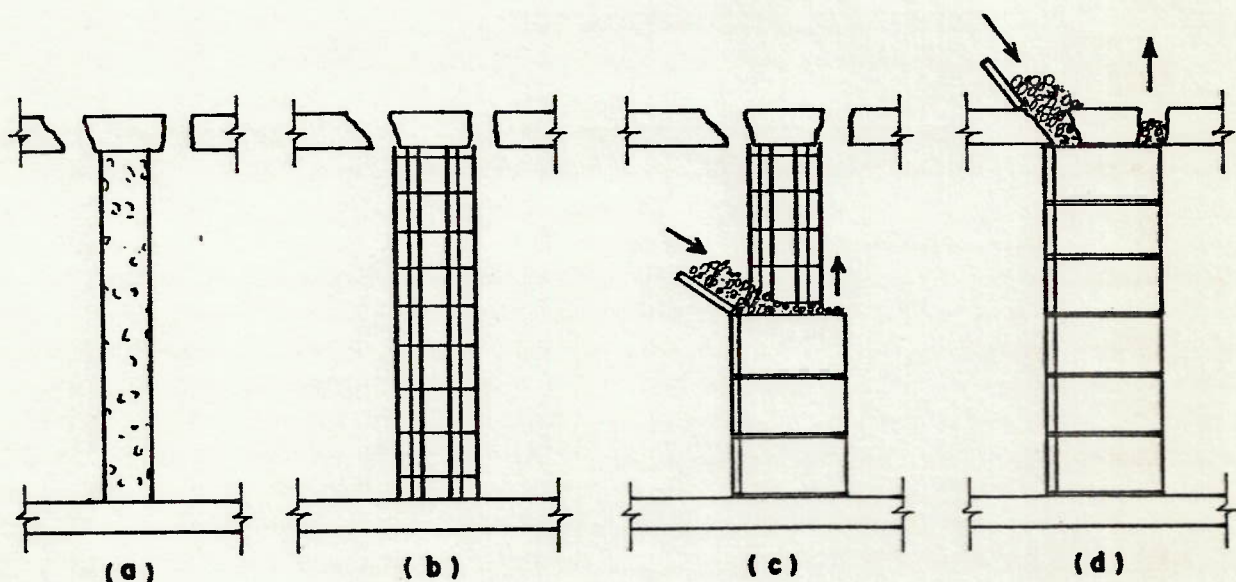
Reforço de pilar com concreto e armaduras suplementares
